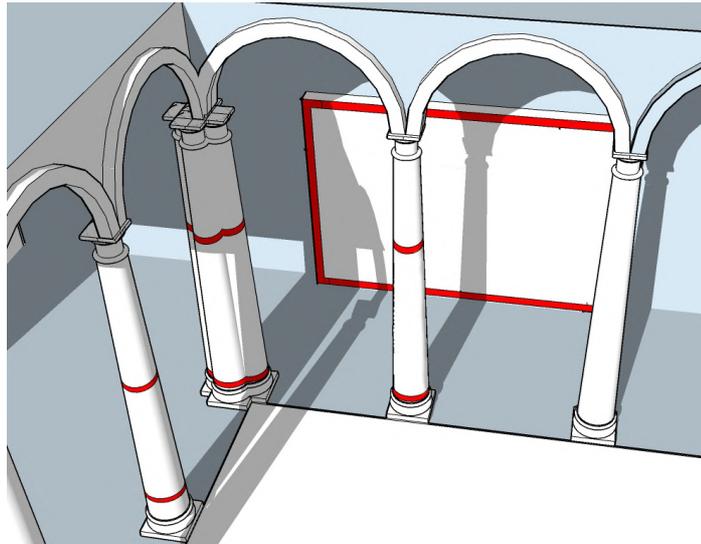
Vista del espacio con las franjas rojas ya delimitadas en las columnas.
